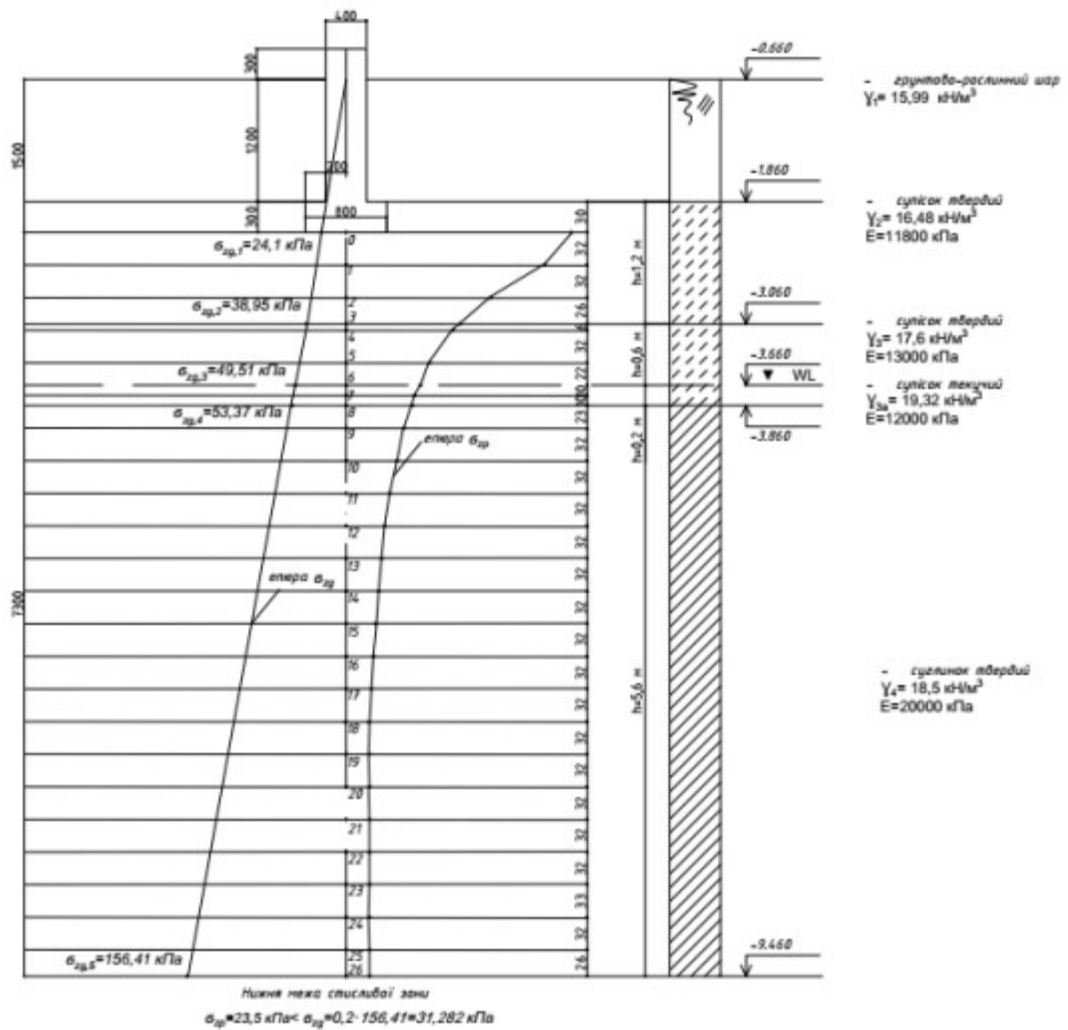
Схема до розрахунку осідання фундаменту методом шарового підсумовування
